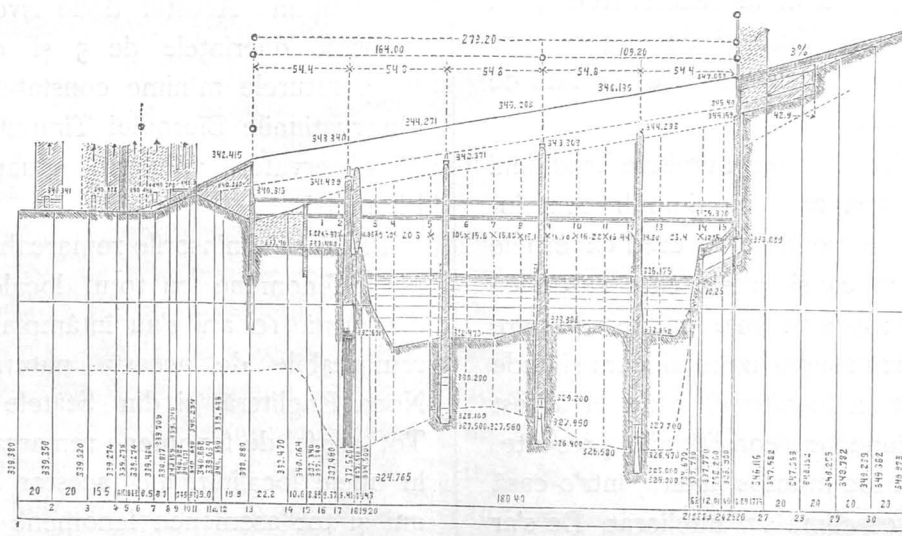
Profil longitudinal al noului pod între Braunau și Simbach.
